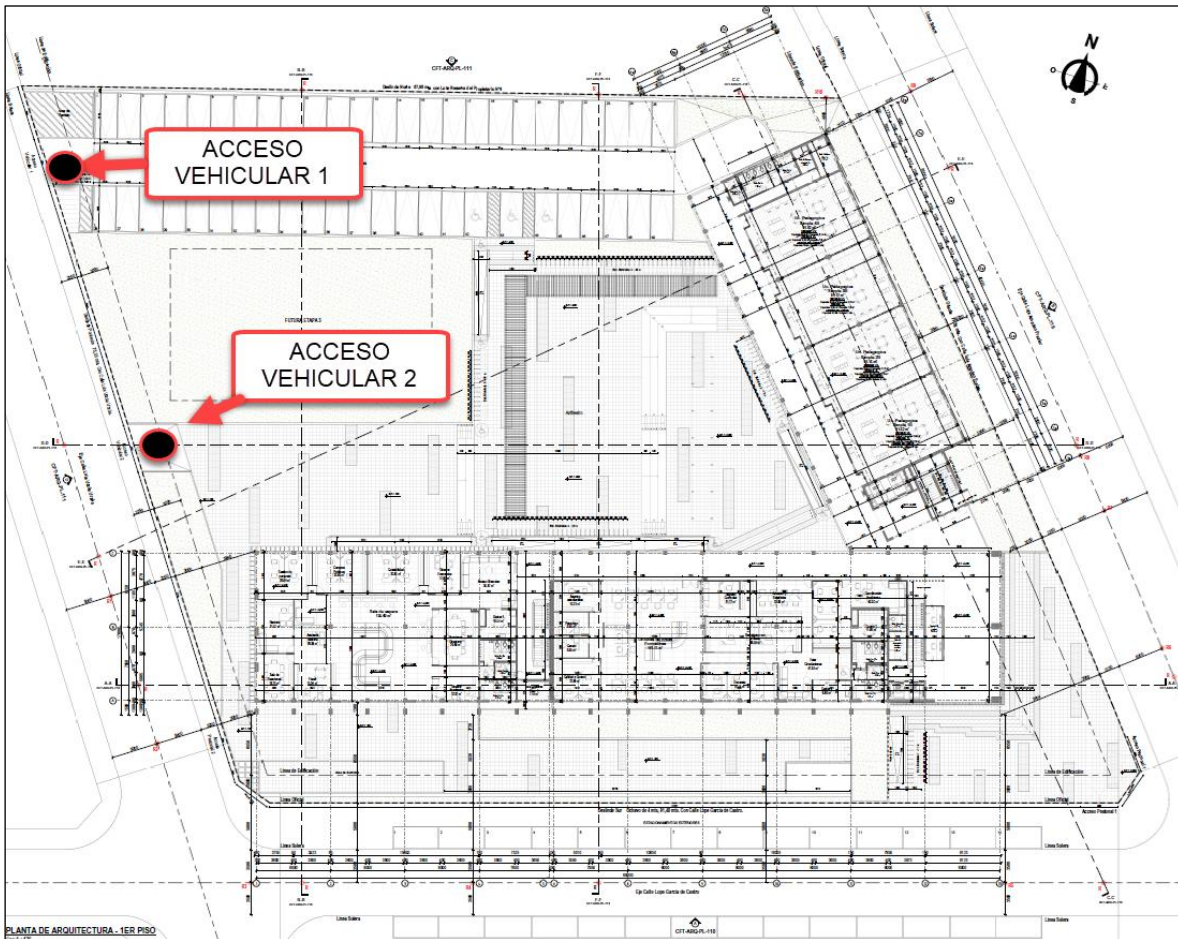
Accesos vehiculares proyectados – Planta primer piso
